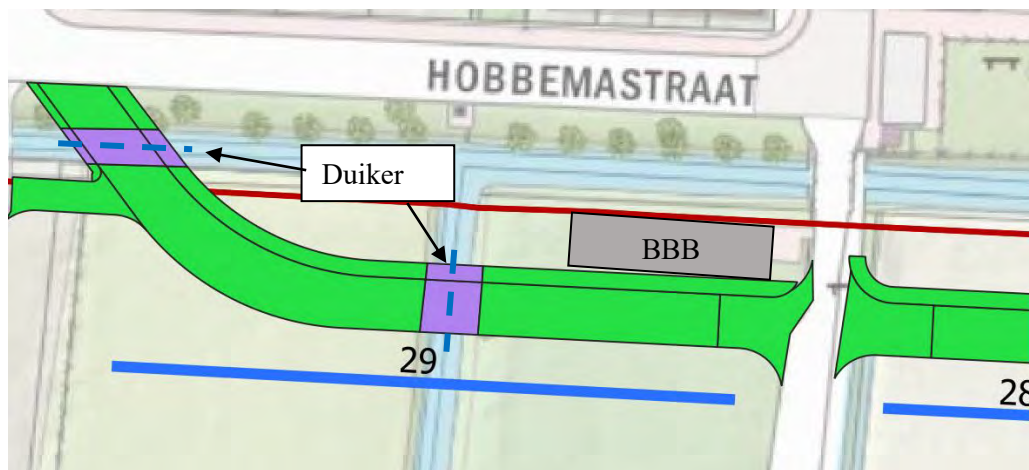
overzicht nieuwe situatie kunstwerken bij aansluiting Jan van Eycklaan en Zilverschoon
